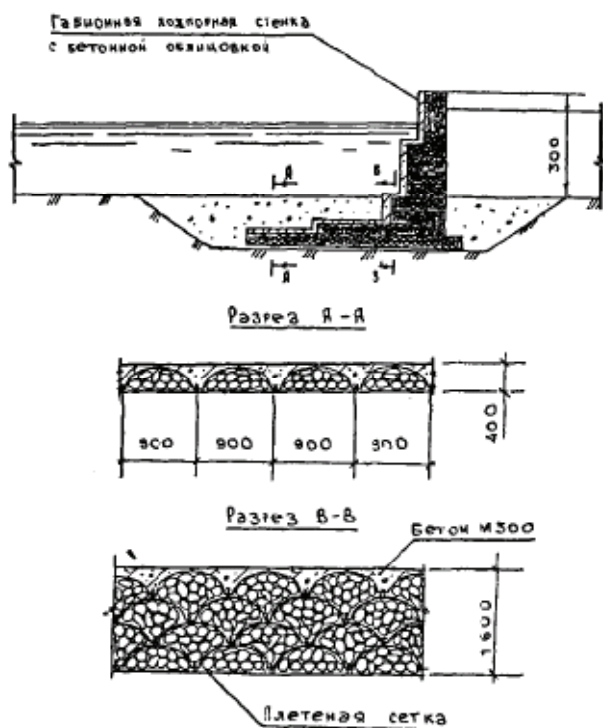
Габрионная подпорная стенка с бетонной облицовкой (вариант 4)
